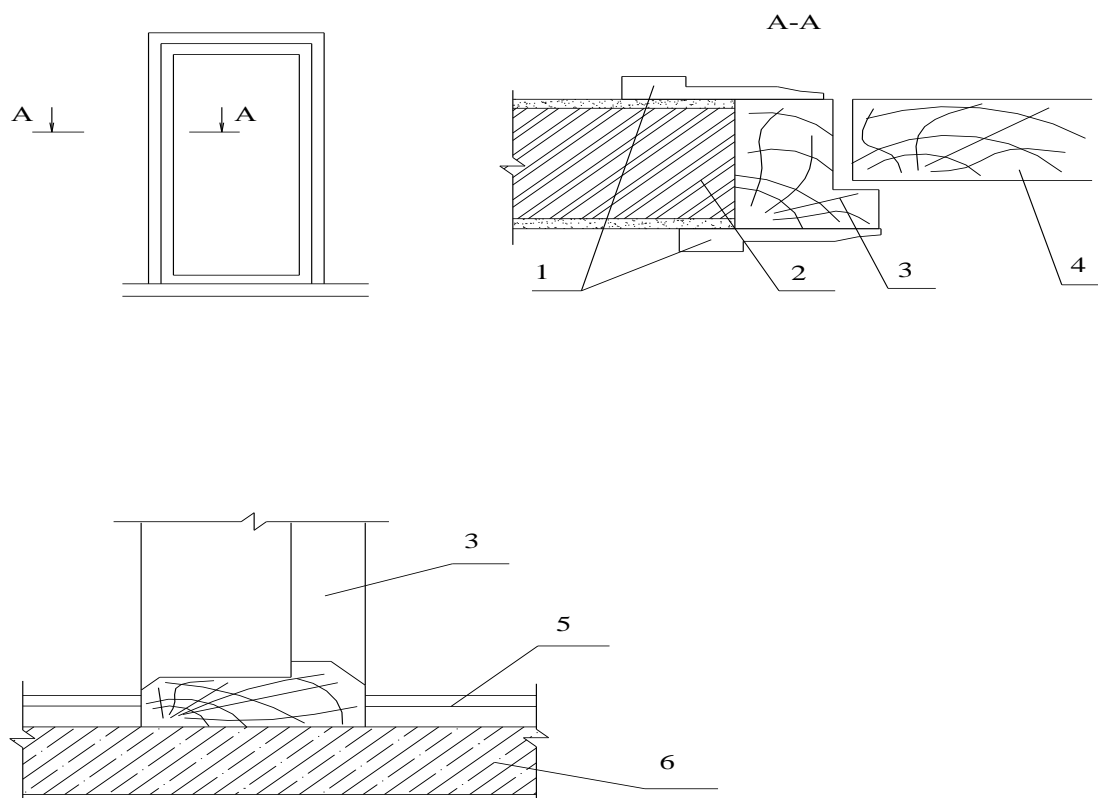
Детали и узлы крепления дверных коробок.
